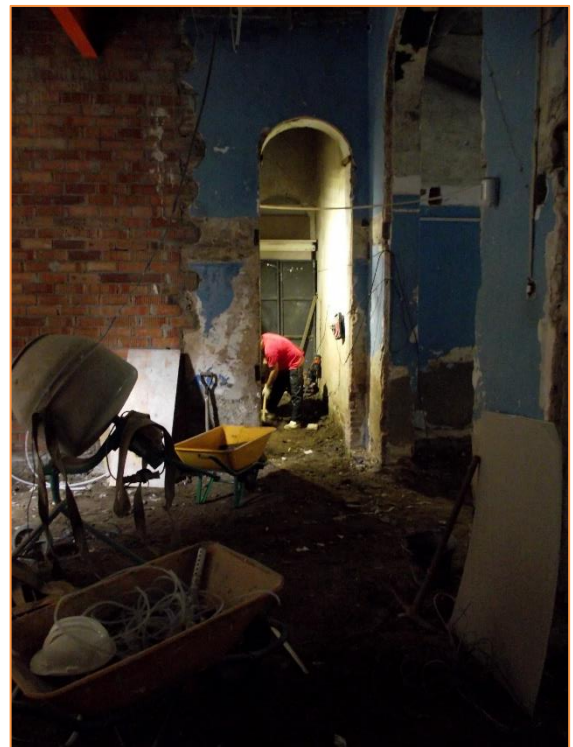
Vista de la planta baixa de la finca. Al fons, el pati on es va realitzar l'excavació del fossat.
